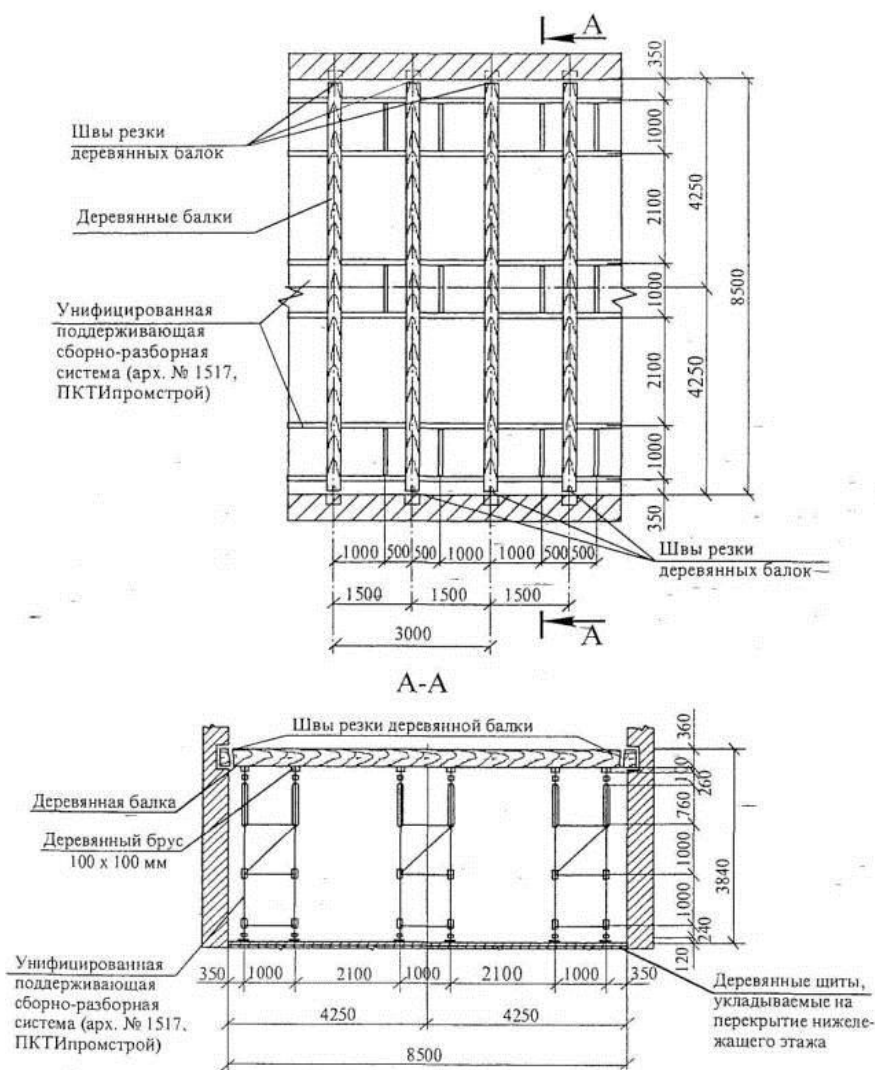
Схема разборки междуэтажного перекрытия по деревянным балкам
